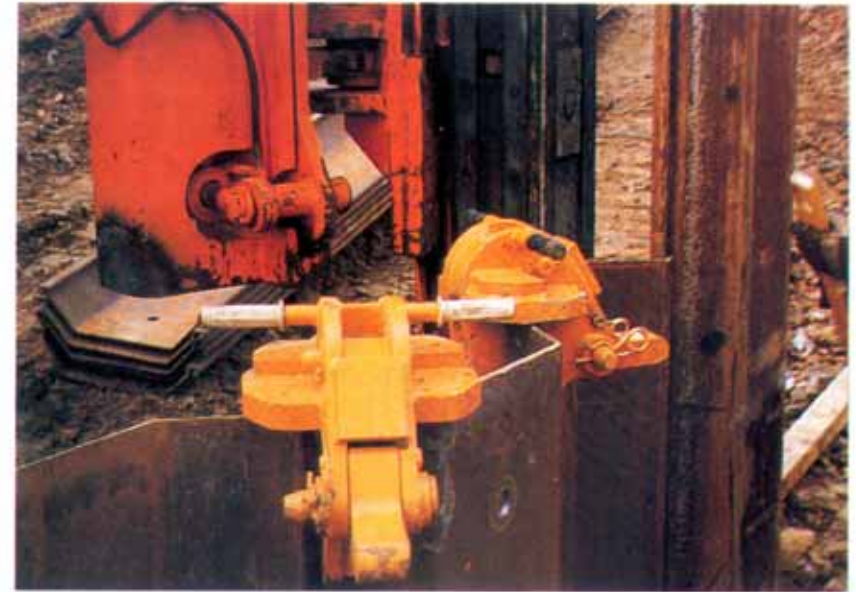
CRAMONS DE BLOCAGE SUR DES PALPLANCHES SIMPLES
